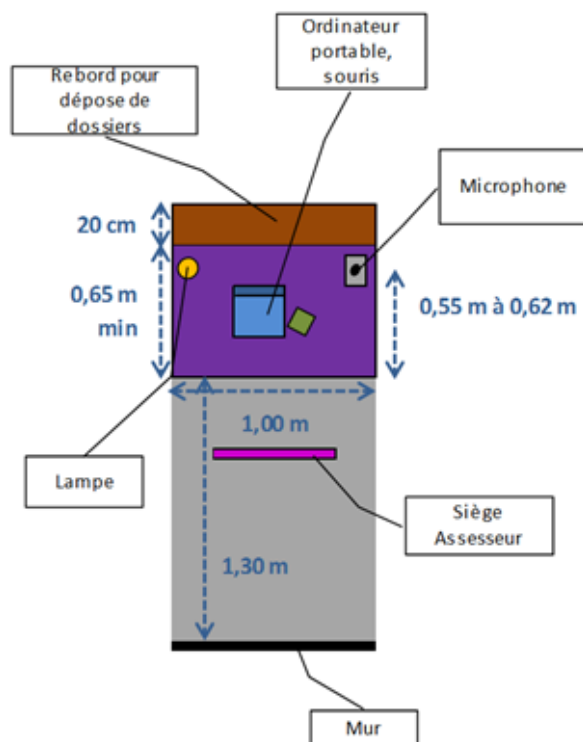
Schéma en plan, poste de travail des assesseurs – Salles d'audience publique pénale et civile
